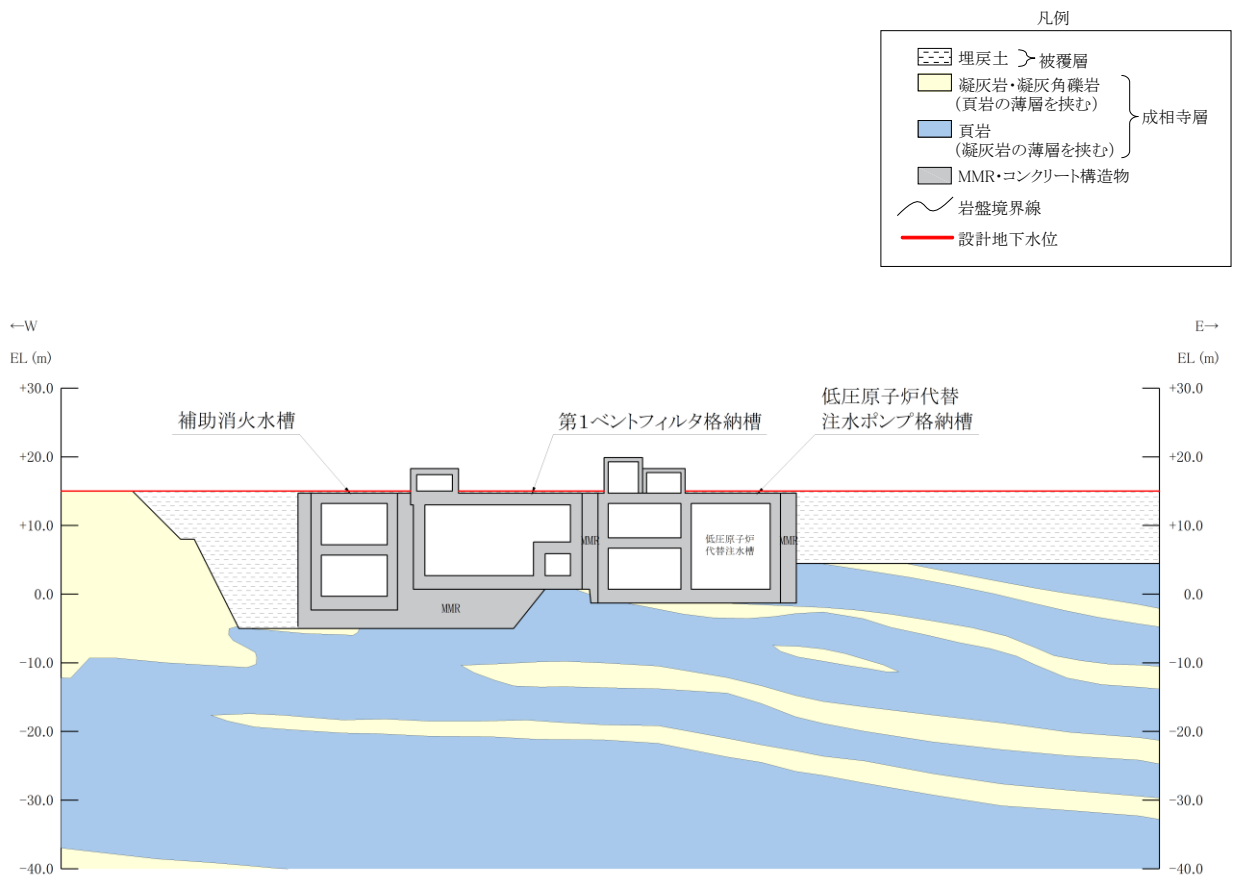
第 1 ベントフィルタ格納槽 評価対象断面図 (C-C 断面)
